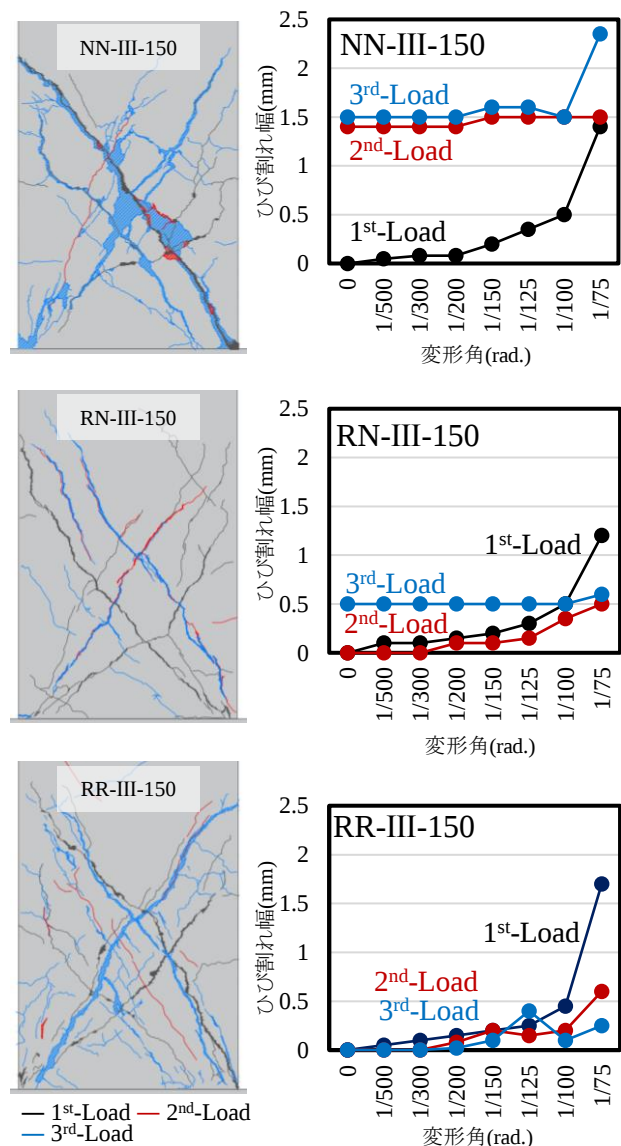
ひび割れ発生状況と最大残留ひび割れ幅の推移
